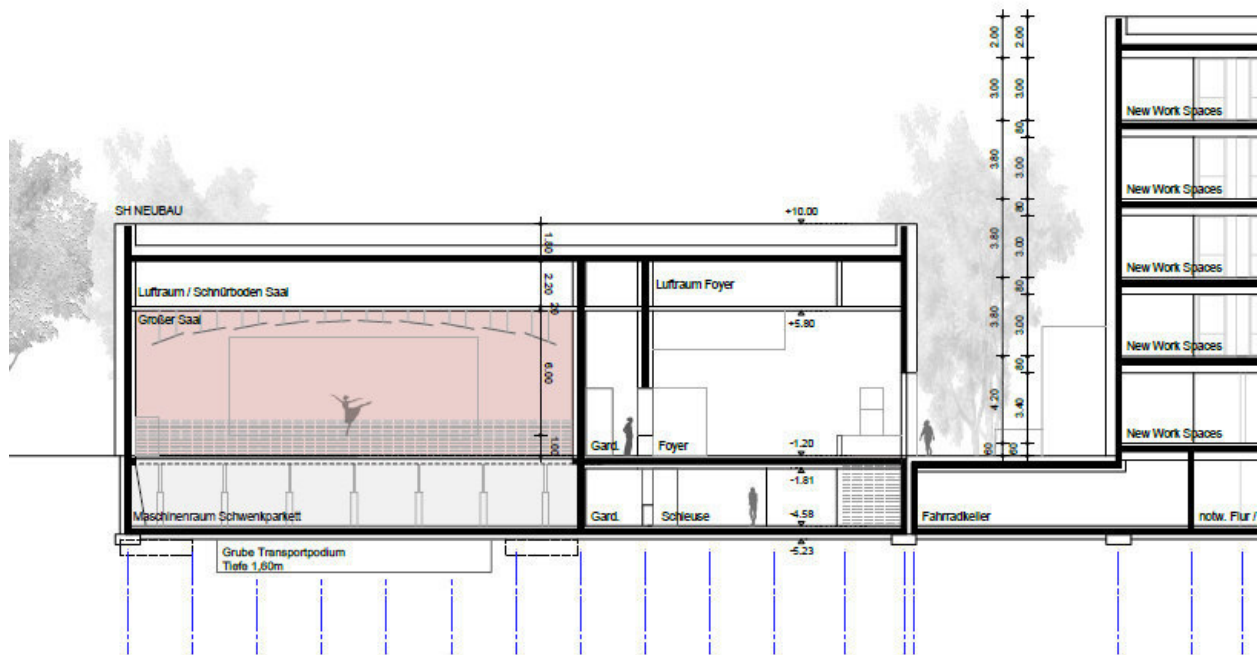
Querschnitt Stadthalle gemäß [3.6]
